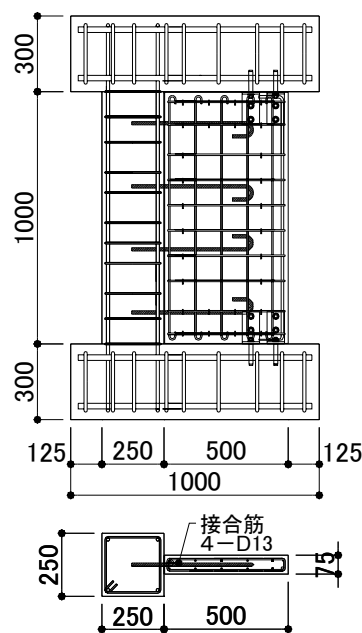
増設袖壁付き柱試験体の配筋図 (例: 試験体 RCSW-3)
